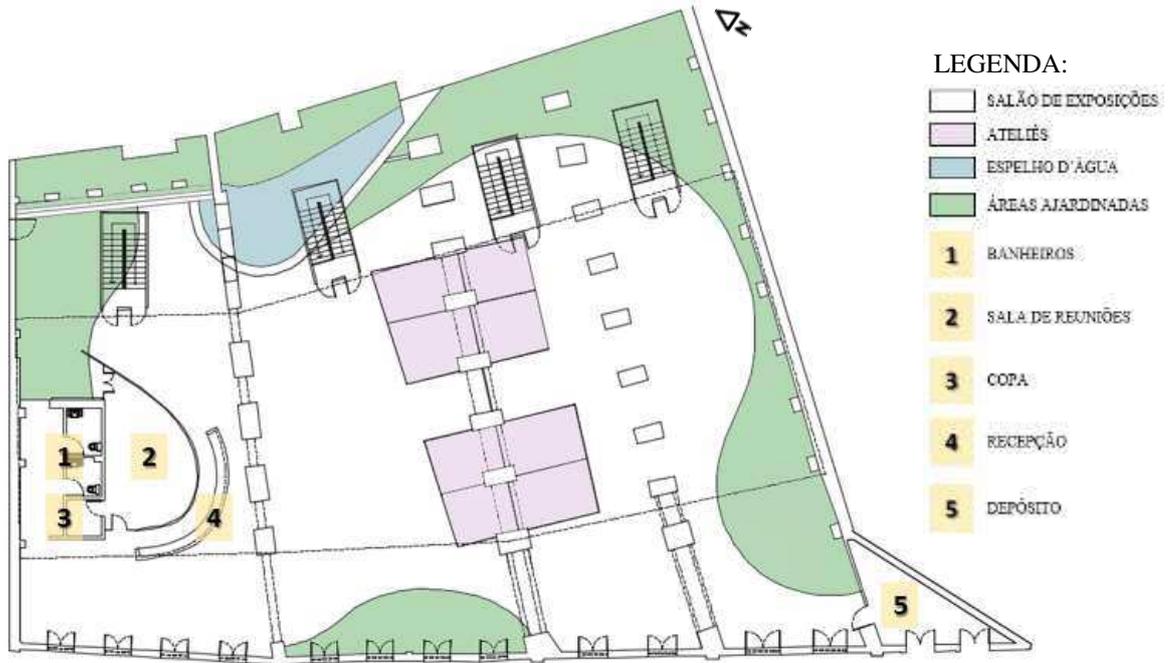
Reprodução da planta baixa original do pavimento térreo do prédio Morada das Artes.
